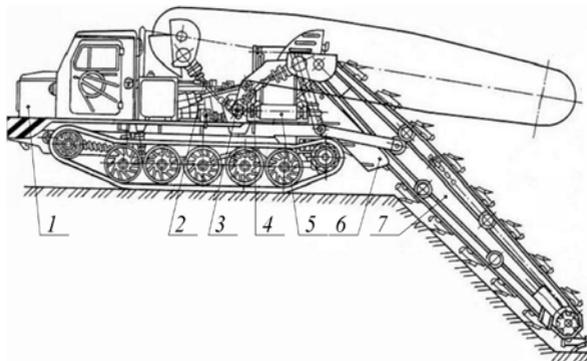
Скребковый цепной траншеекопатель ЭТЦ-252: 1 – базовый трактор; 2 – гидропривод; 3 – трансмиссия; 4 – механизм подъема и опускания рабочего органа; 5 – поперечный ленточный конвейер; 6 – подъемный лоток; 7 – рабочий орган
